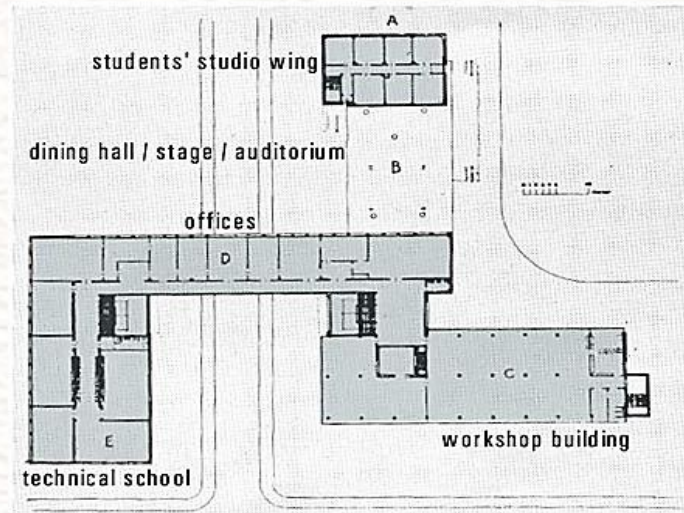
Zum Vergleich: Grundriß des Bauhauses in Dessau (1925/26; W. Gropius; 1. Obergeschoß). Das Bauhaus gilt als eines der wichtigsten Gebäude der „klassischen Moderne“ und zeigt eine exemplarisch frei komponierte Grundrißfigur.
